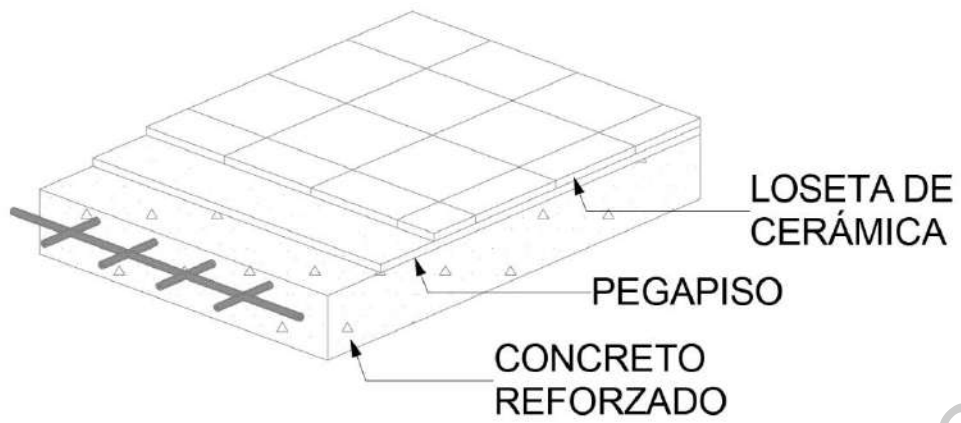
Detalle de losa de cimentación. Elaboración propia.
